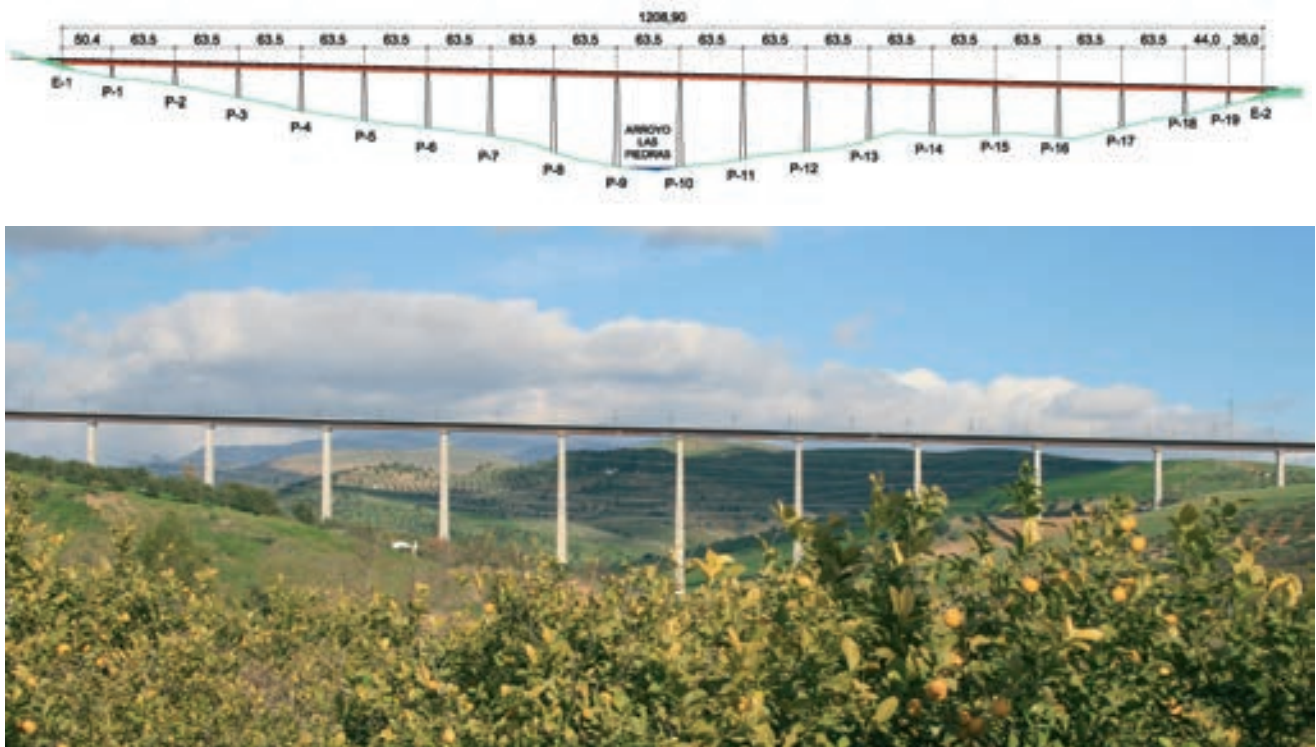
Alzado y vista del Viaducto Arroyo las Piedras
